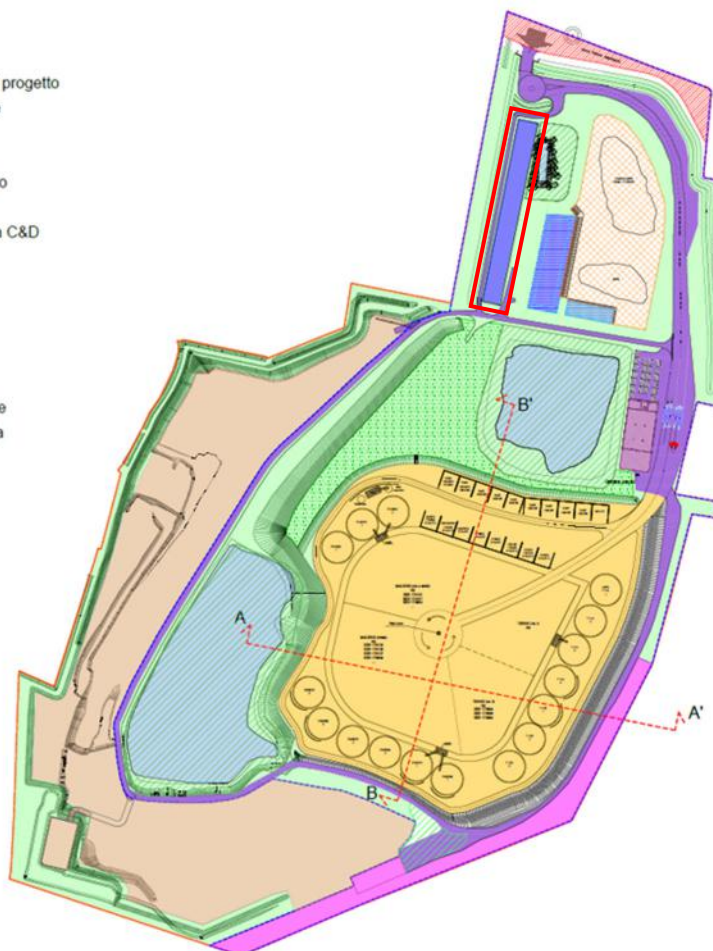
Individuazione zona impianto fotovoltaico (stralcio Tav. PF-T11)
